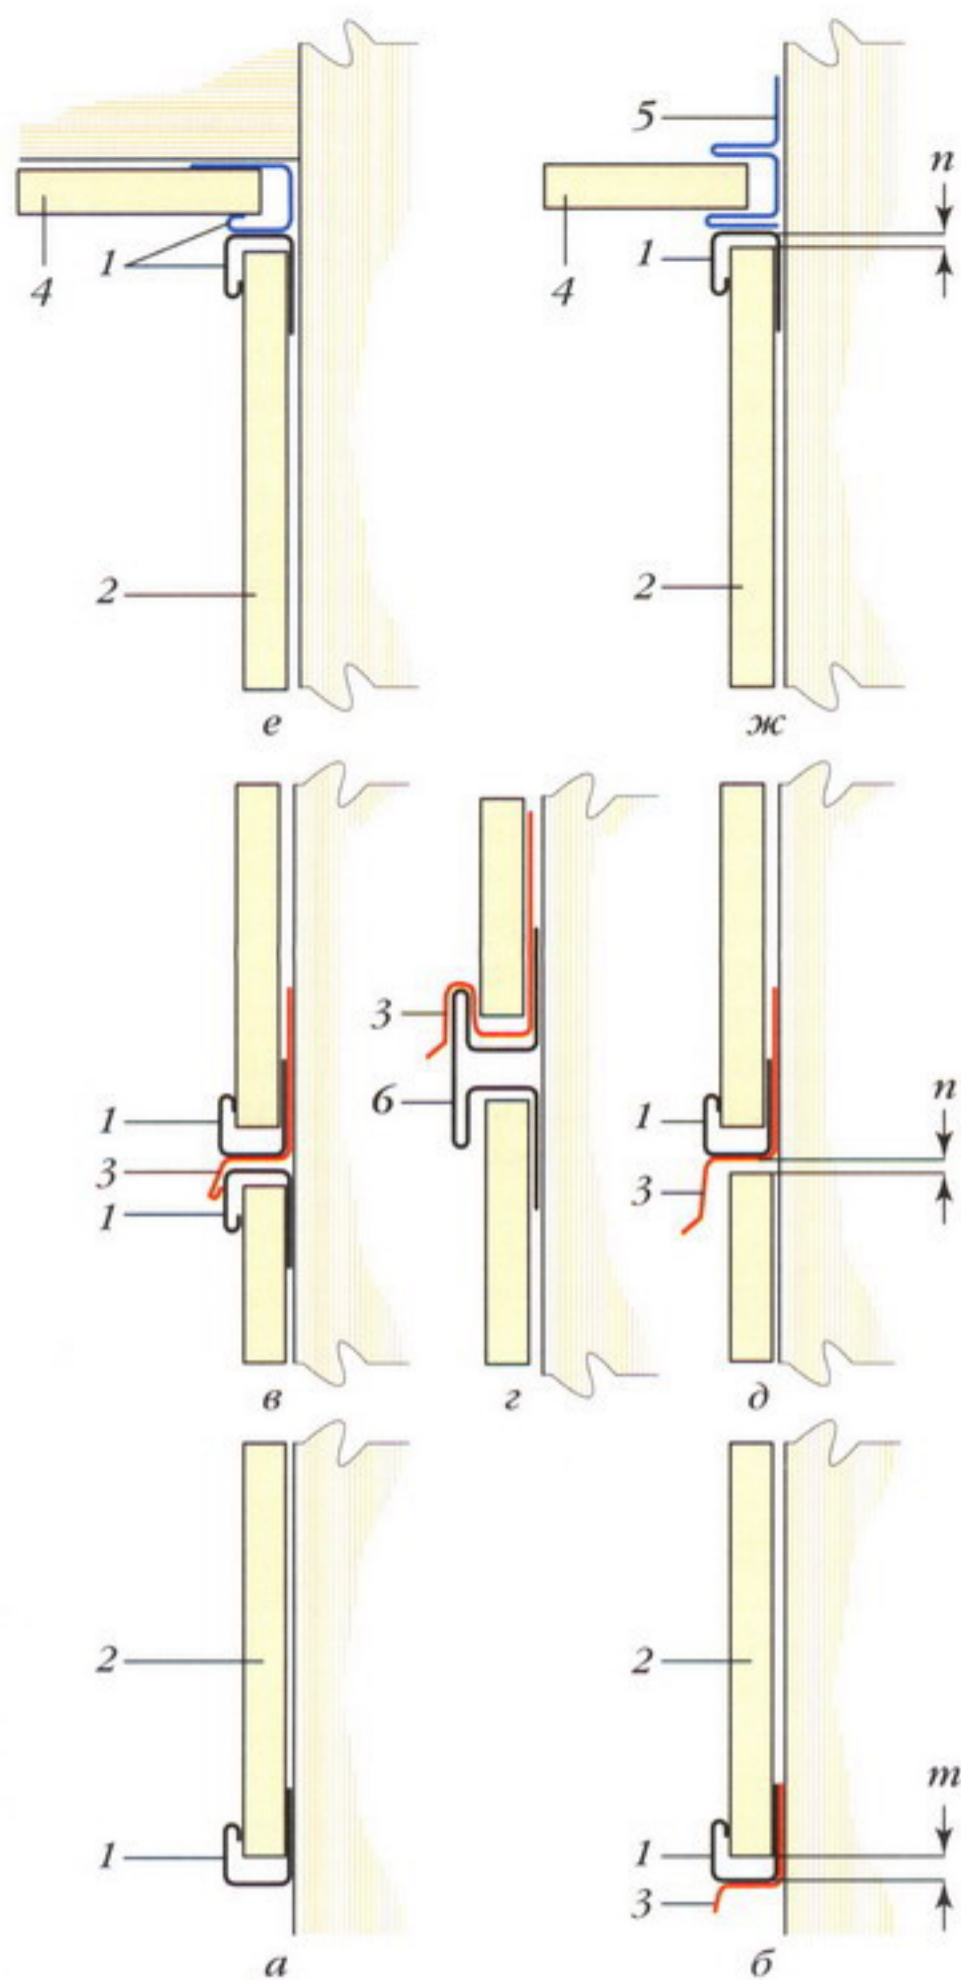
Варианты стыкования вертикального сайдинга на стене: а – нижний узел примыкания сайдинга к принимающему профилю; б – то же, с отливом; в – стыкование на двух J-профилях с отливом; г – стыкование на H-профиле или виниловой доске с отливом; д – стыкование на J-профиле и отливом; е – примыкание к софиту на двух J-профилях; ж – то же, на J и F-профилях; 1 – J-профиль; 2 – вертикальный сайдинг; 3 – отливы различных конфигураций; 4 – софит; 5 – F-профиль; т, п – 2/3 и 1/3 от общего температурного зазора соответственно
